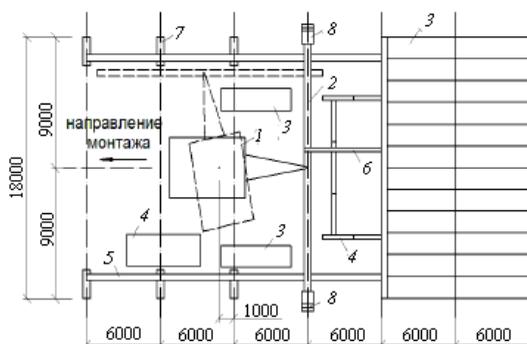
Схема монтажа здания фильтров водоочистной станции: 1 – кран; 2 – стропильная ферма; 3 – плиты покрытия; 4 – стеновые панели фильтра; 5 – подкрановая балка; 6 – распорка; 7 – колонна; 8 – лестница приставная
